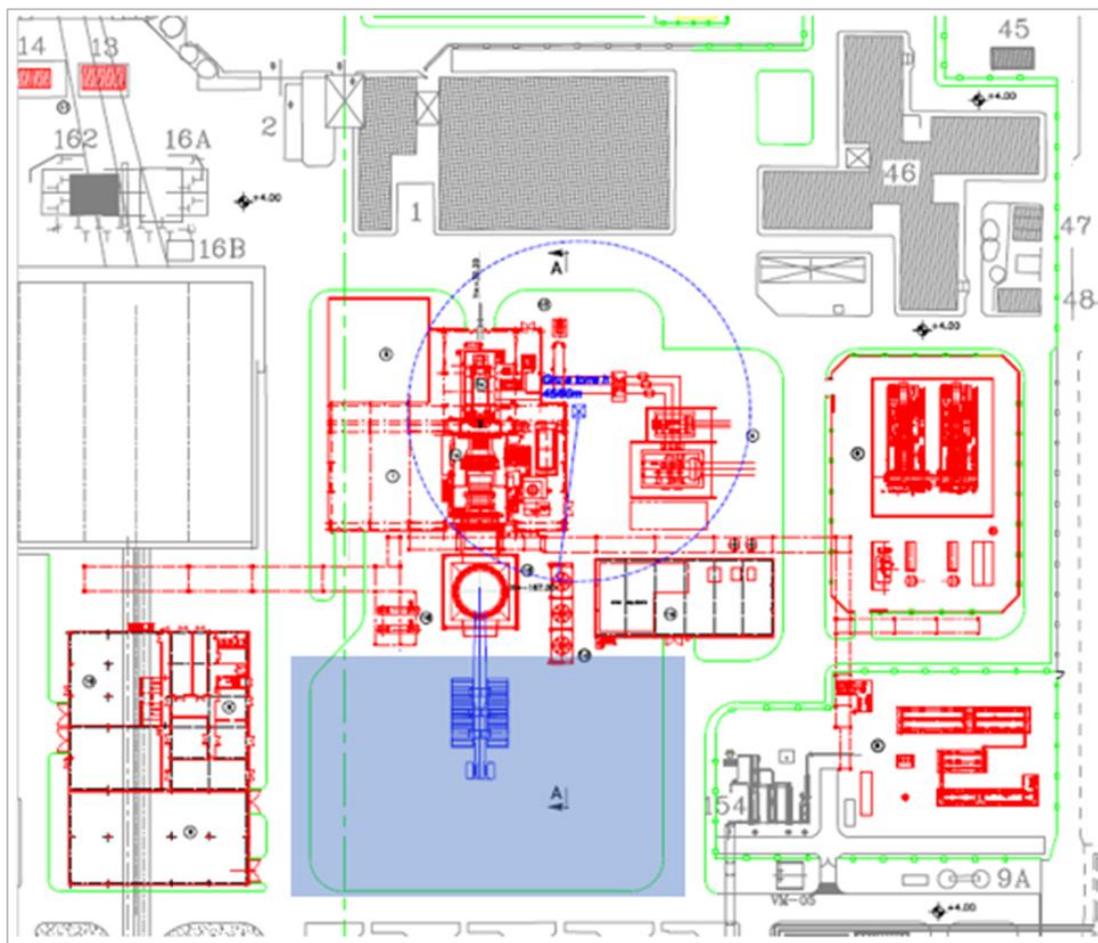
Cantiere Fase-1: area prefabbricazione e stoccaggi temporanea e area montaggi
